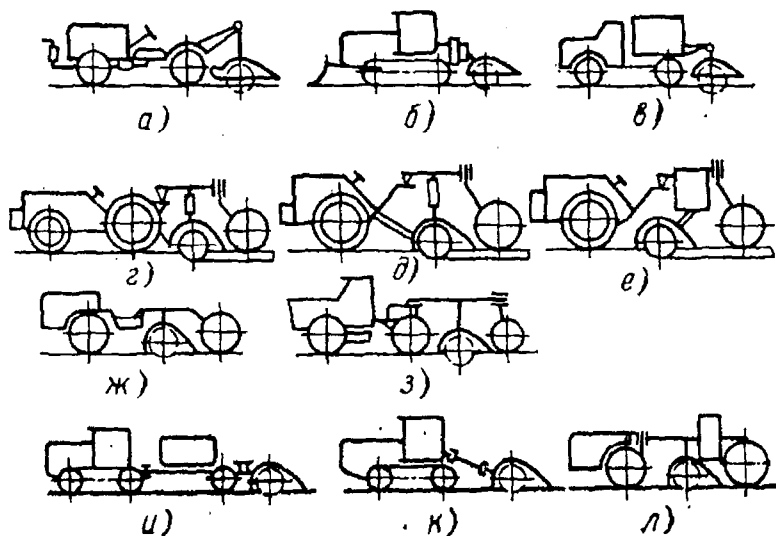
Схемы компоновок дорожных фрез: а, б, в – навесные фрезы на базе пневмоколесного, гусеничного тракторов и автомобильного шасси; г, д – полунавесные фрезы на базе пневмоколесного трактора и одноосного пневмоколесного тягача; е – полунавесная фреза на базе одноосного тягача со специальным двигателем для привода ротора фрезы; ж, з – самоходные фрезы на одноосном и двухосном пневмоколесных тягачах; и, л – прицепные фрезы к гусеничному трактору и одноосному тягачу со специальным двигателем для привода ротора фрезы; к – прицепная фреза к гусеничному трактору с приводом от двигателя тягача.
